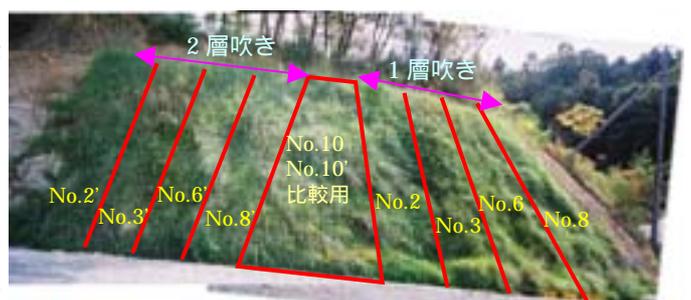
現場吹付け実験植生状況(施工後1ヵ年経過)
